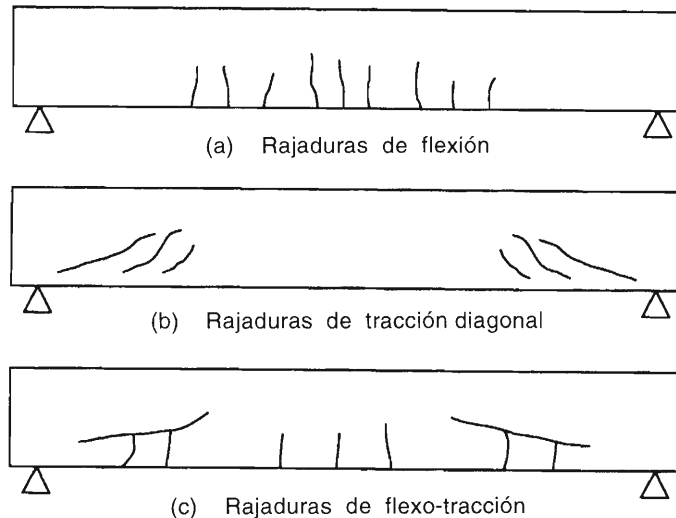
Tipos de rajaduras que presentan las vigas de concreto armado
